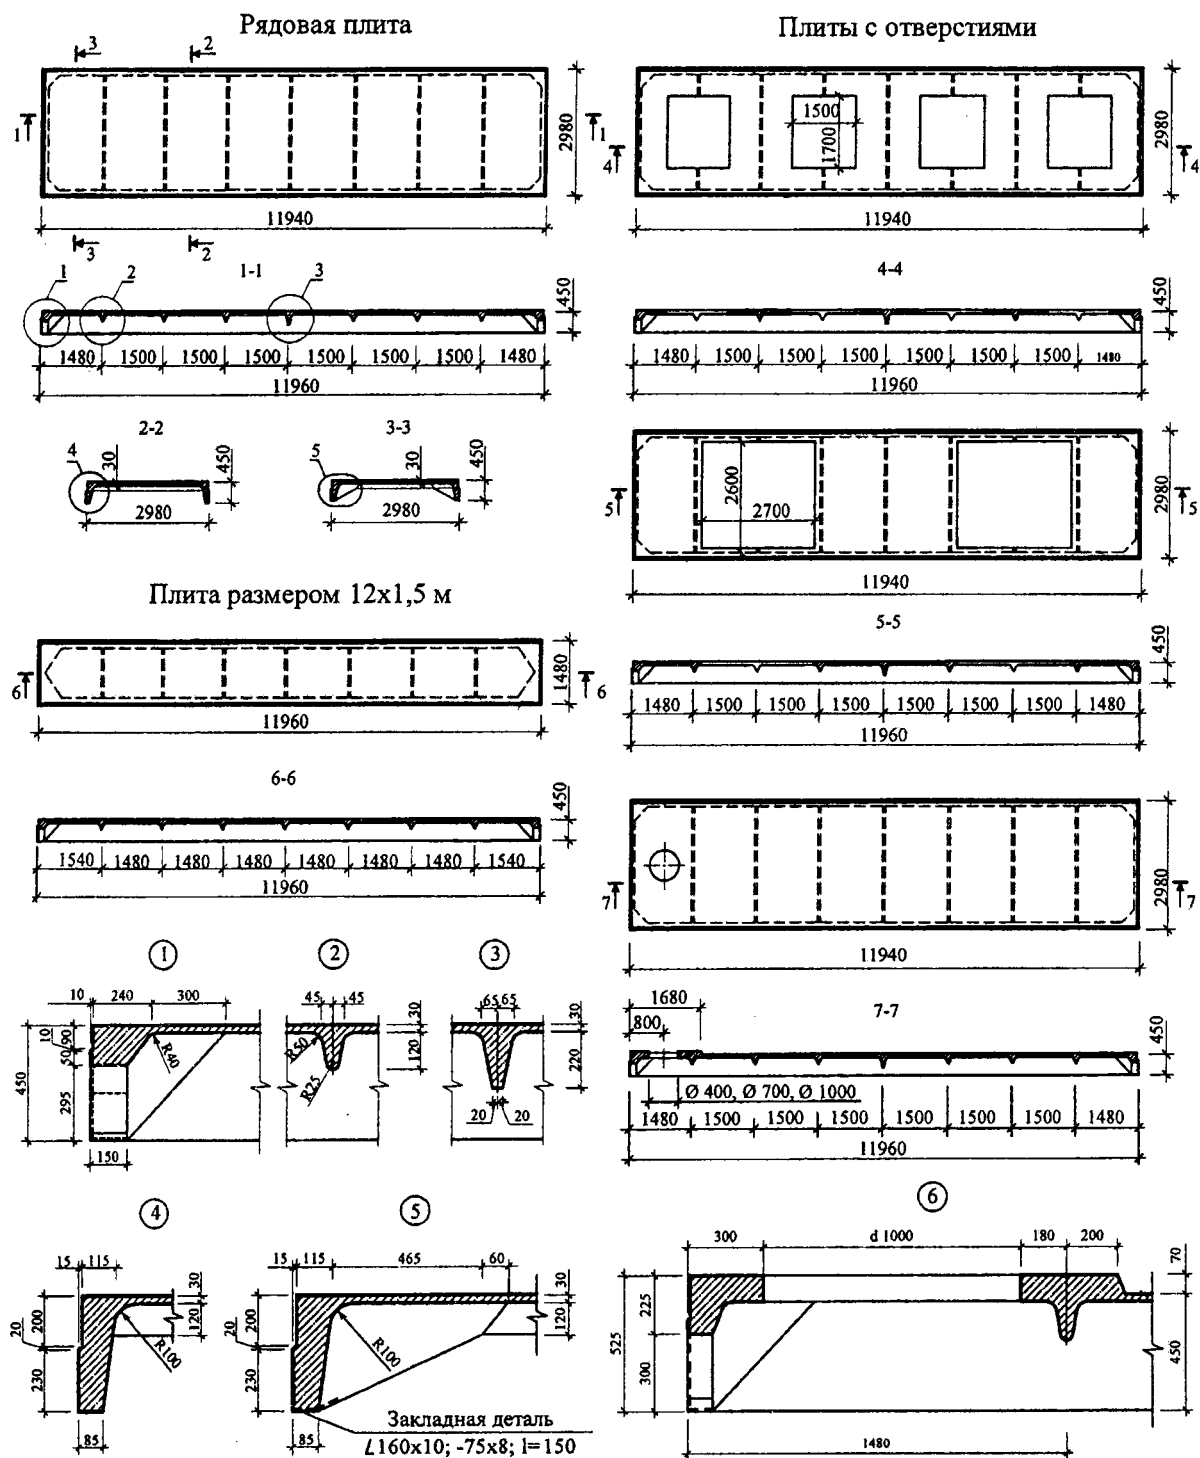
Железобетонные ребристые плиты покрытий пролетом 12 м
